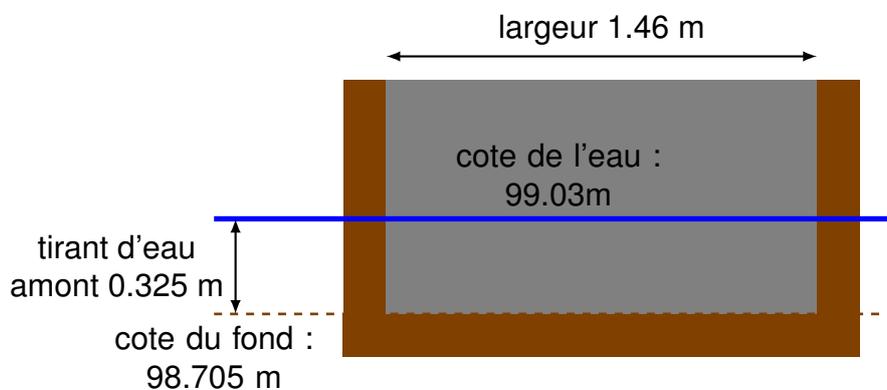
Coupe transversale du batardeau (bois)
